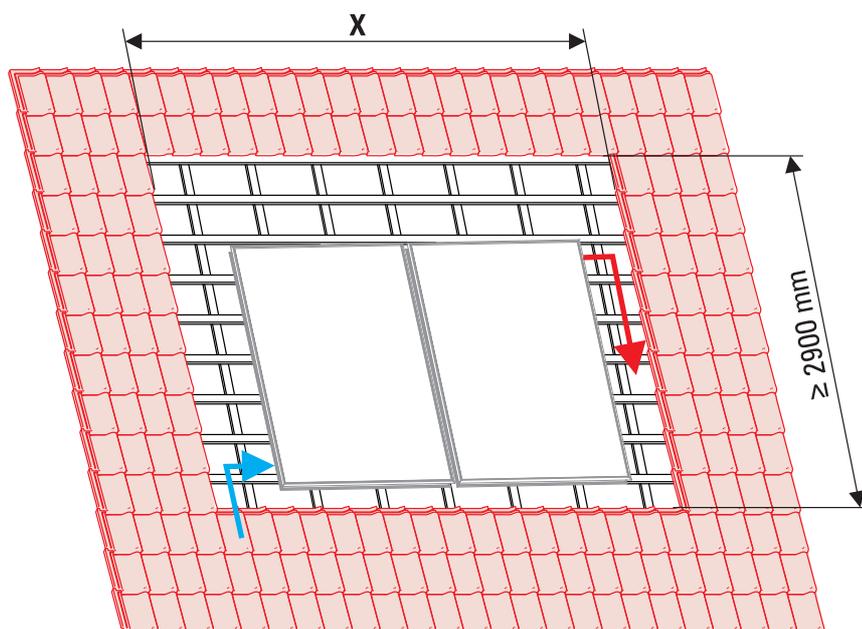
Copertura superficie piana (dimensione X = dimensione C in tab. 3-3)
